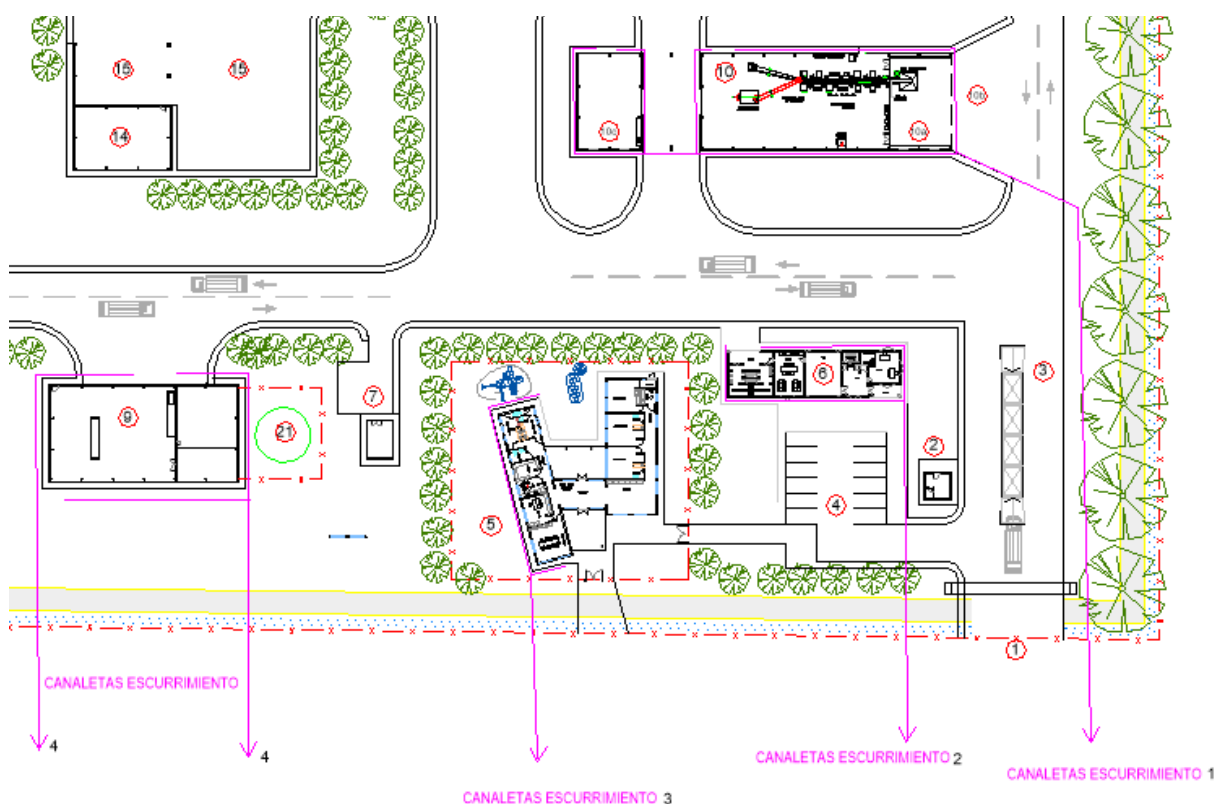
Disposición de las canaletas en la Planta de Allen (canaletas 1, 2, 3 y 4).
